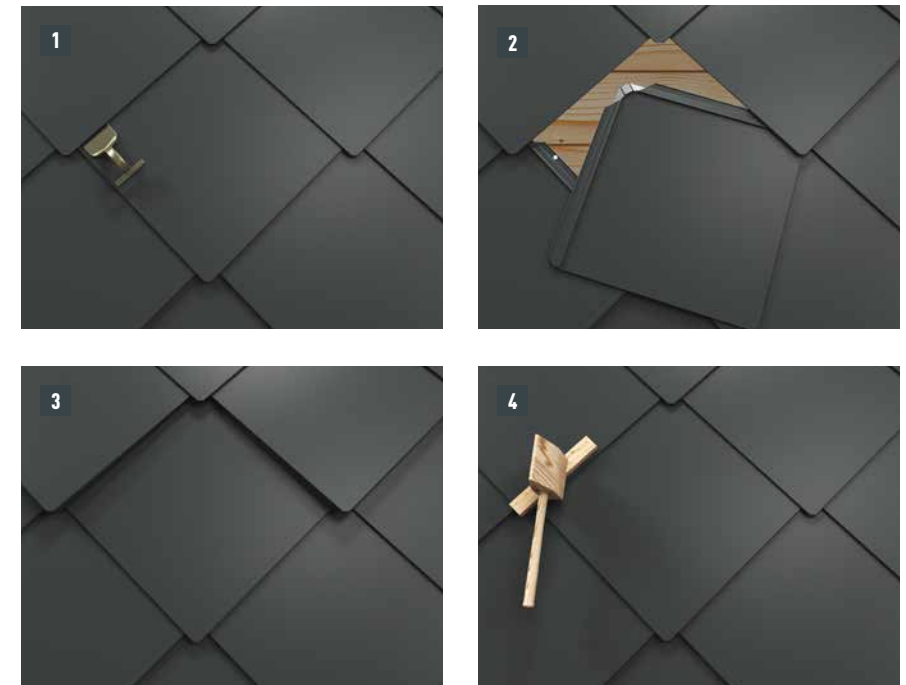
· Wandraute 44×44 – Deckrichtung und Befestigung
